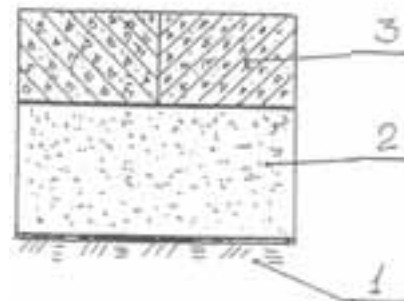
Конструкция временной дороги при опытно-строительстве с покрытием из железобетонных плит марки 2П 30.18-30В, подлежащих демонтажу по окончании строительства объекта
